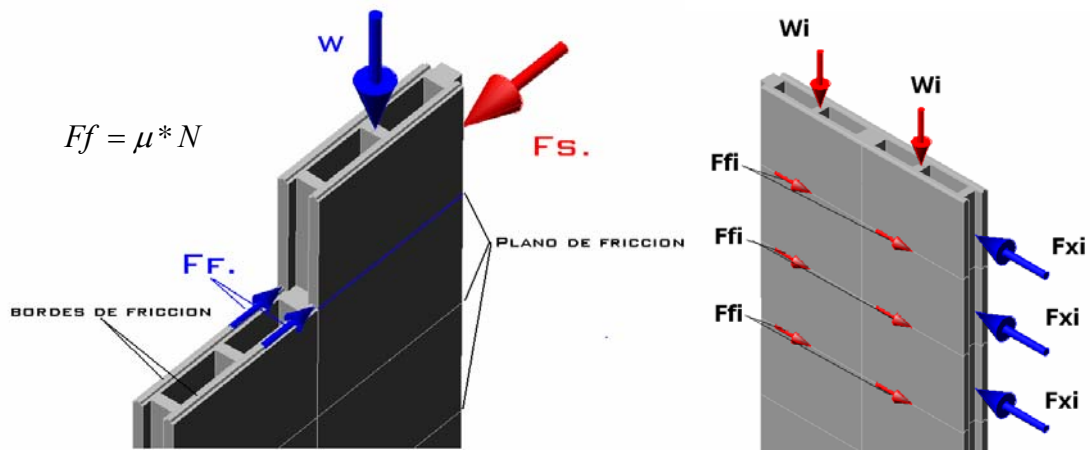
FUERZA DE FRICCIÓN GENERADA EN LOS PLANOS
